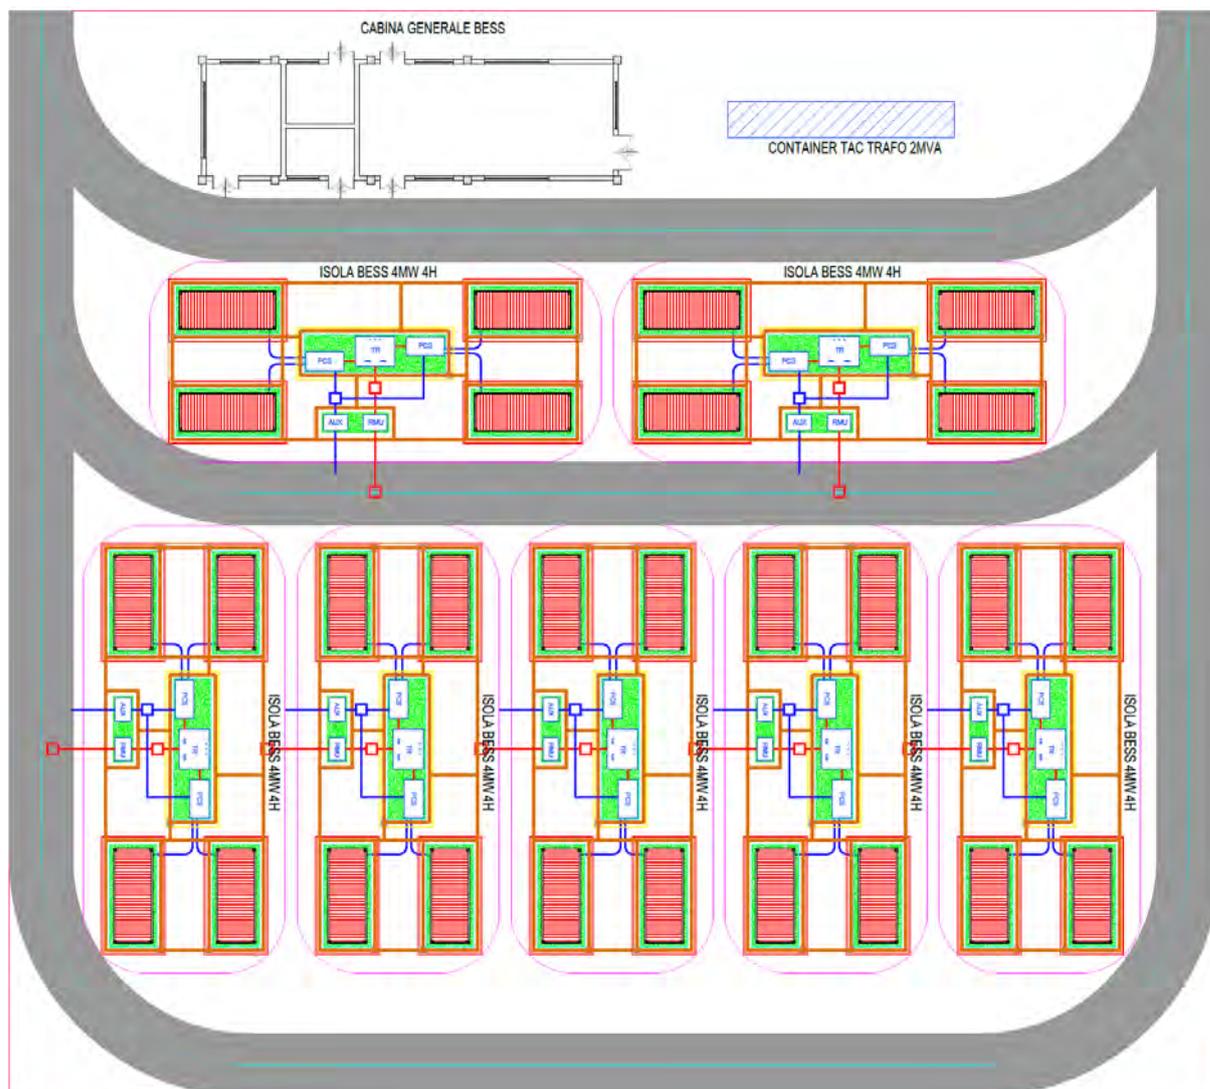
Layout del Sistema BESS 25 MW – 4h
